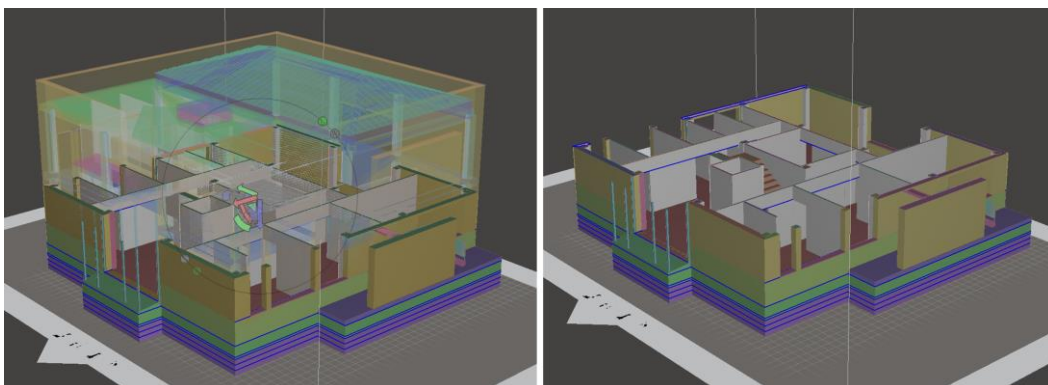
Modelo seccionado con plano de corte horizontal a nivel de forjado
